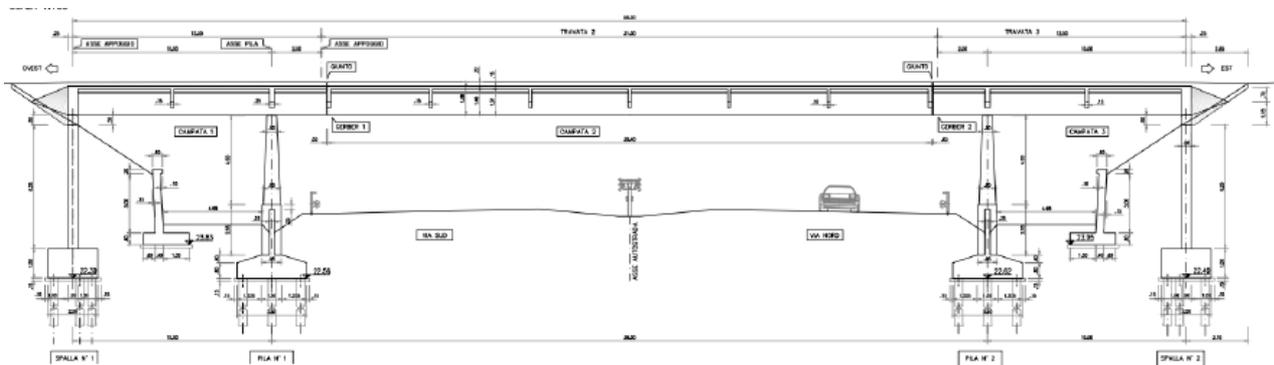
Sezione longitudinale del sovrappasso esistente (Fonte: Allegati alla Lista di controllo)
